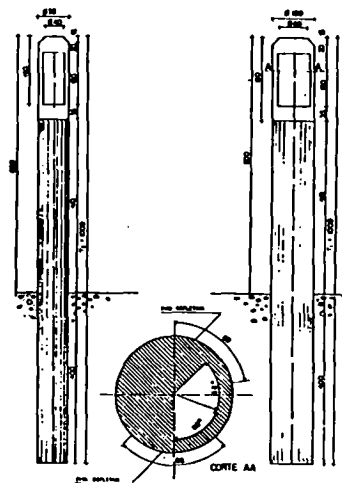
Exemplo de Balizador – Tipo Pilarete
